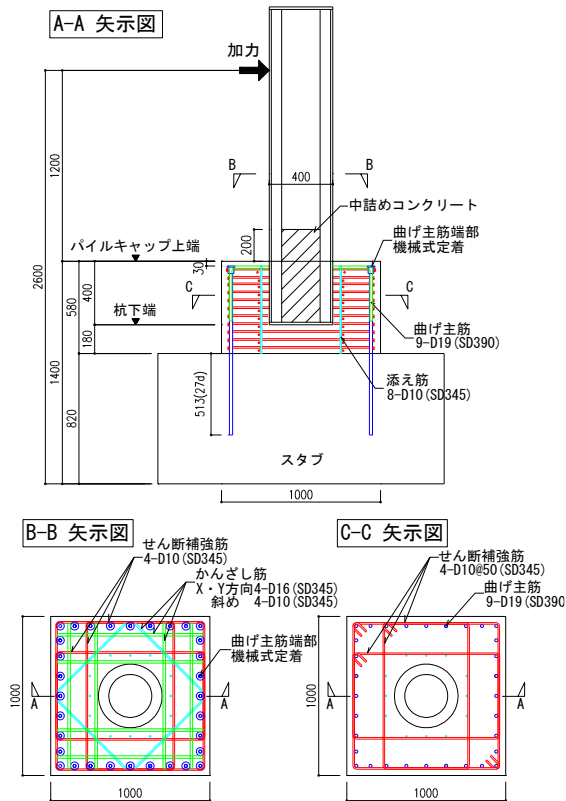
試験体 No. 4 の形状・配筋 (単位: mm)
